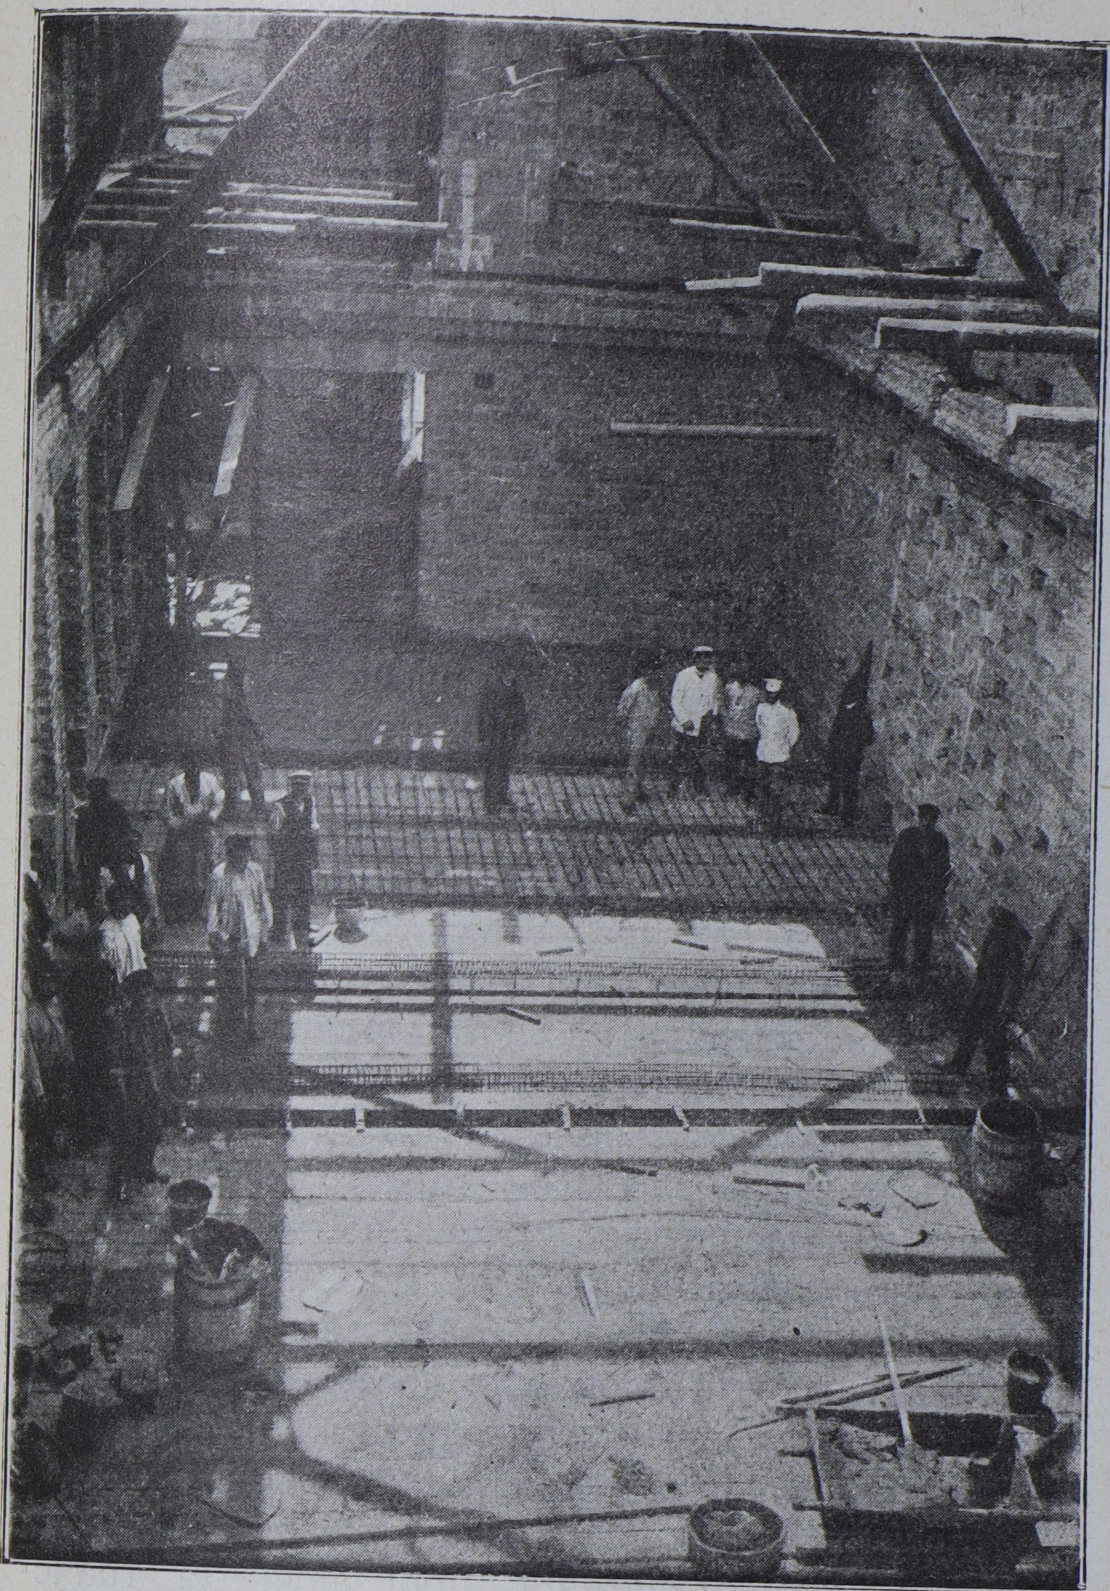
Перекрытие (подъ столовой) въ здании Эконом. О-ва Офицеровъ Одесскаго В. О., сооруженное фирмой В. И. Кундерть и К<sup>о</sup> въ Одессѣ. Усиленіе сжатого пояса балокъ спиральной арматурой сист. инж. Н. Абрамова.
